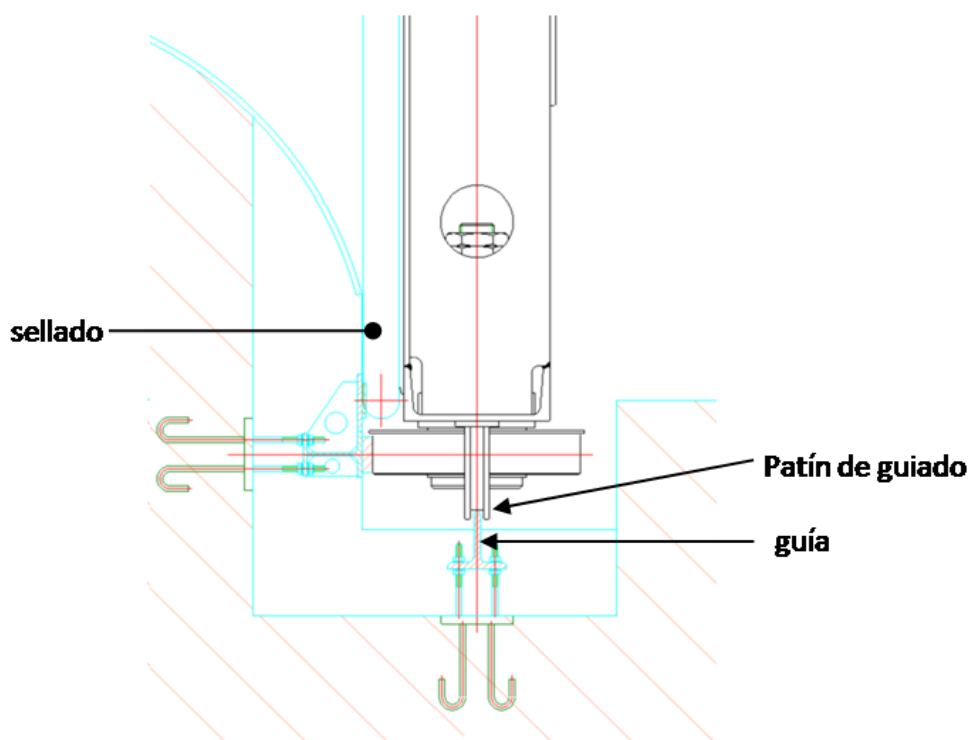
Ubicación de los patines guía en el tablero compuerta mural.
